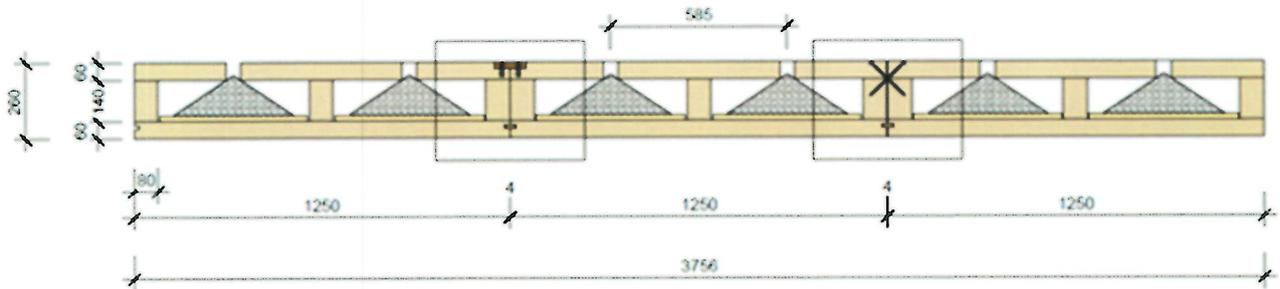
Darstellung Auflagerbereich (Prüfsituation gemäß eingekreistem Detail)
